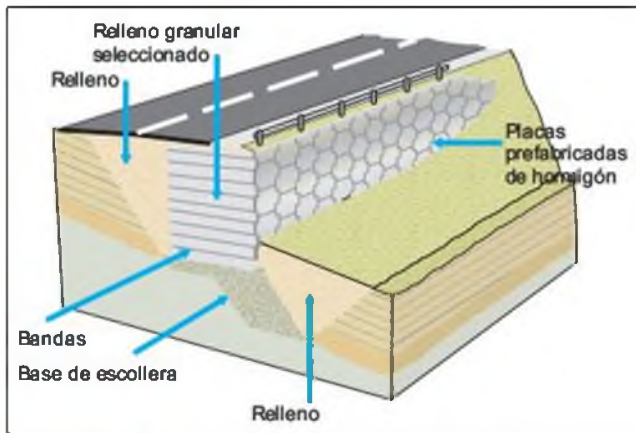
Muro de tierra armada (modificado de CANMET, 1977).
